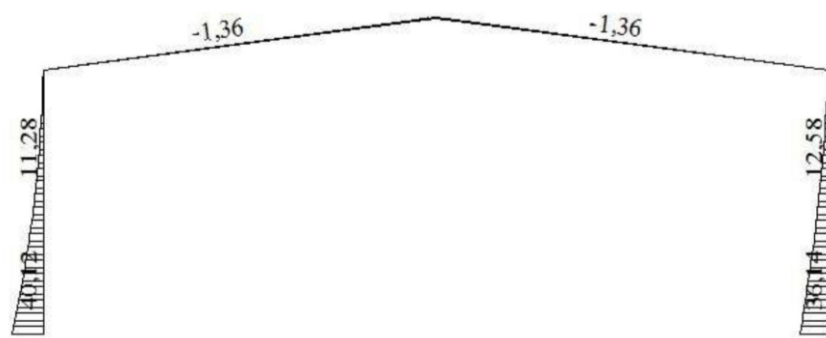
Епюра M для вітрового навантаження зліва будівлі
